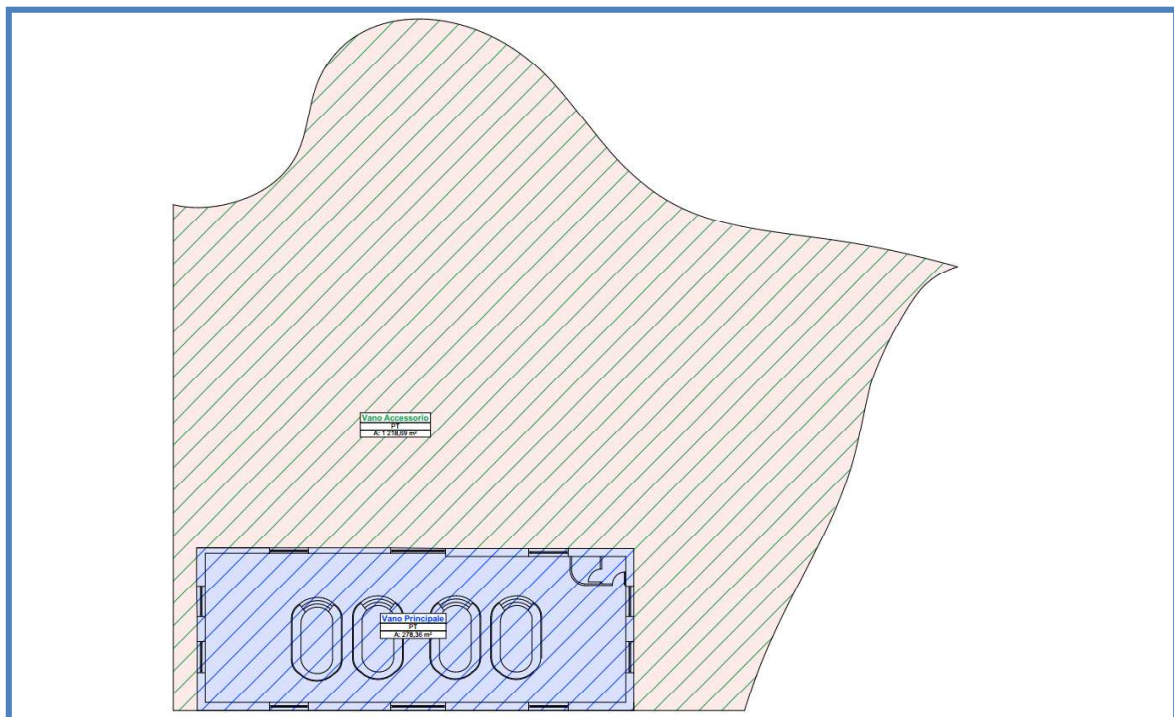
fabbricato ex lavanderia – PIANTA PIANO TERRA
